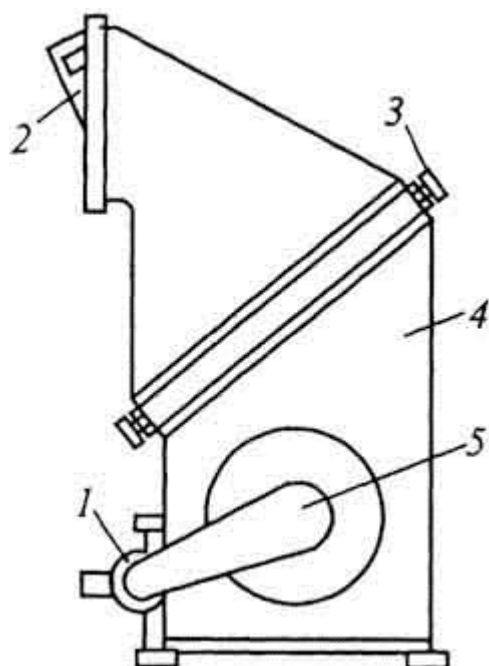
Напольный воздушно-рециркуляционный отопительный агрегат: 1 - электродвигатель; 2 - воздуховыпускной патрубок; 3 - воздухонагреватель; 4 - корпус; 5 - клиноременная передача в защитном кожухе
